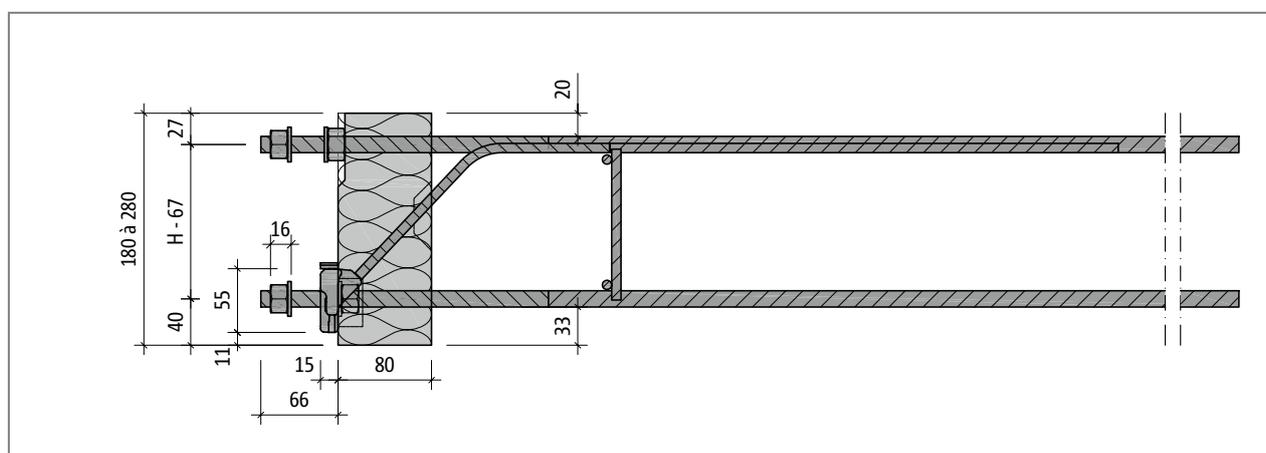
Schöck Isokorb® T type SK-MM1-VV1 : coupe du produit
